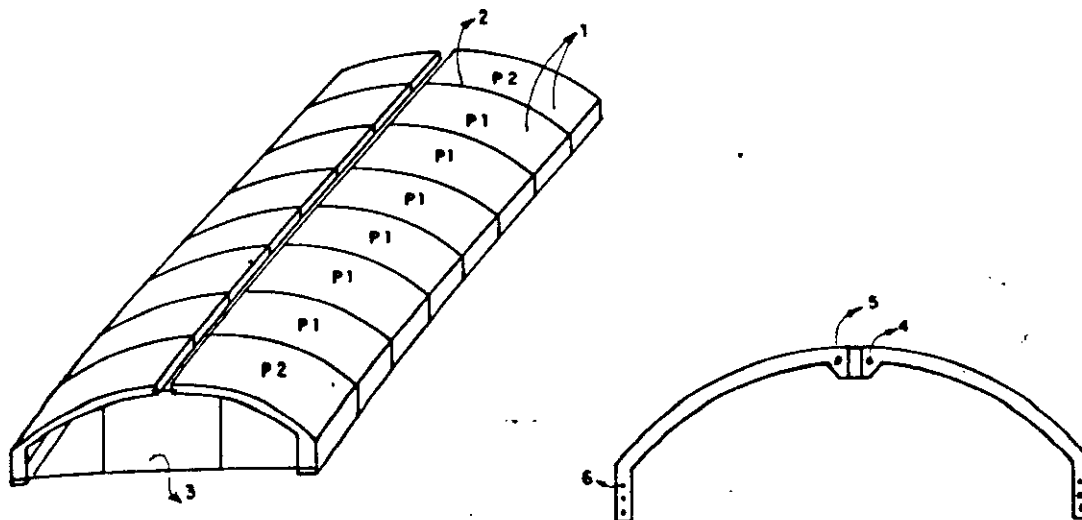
Casca cilíndrica pré-moldada em concreto armado.
